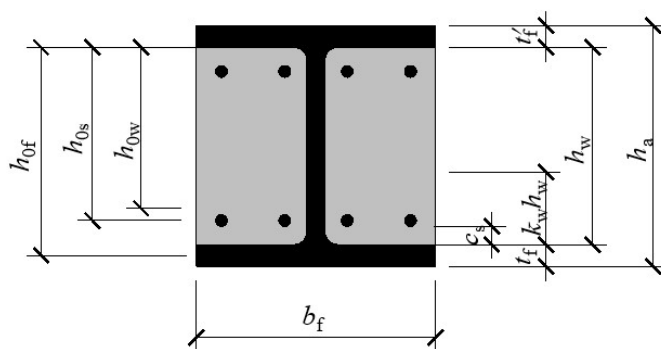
无翼板部分包覆钢-混凝土组合梁最大裂缝宽度计算参数示意
